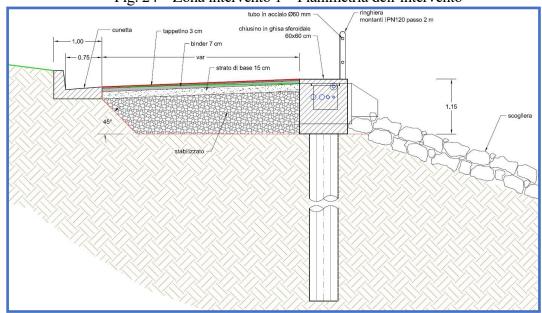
Zona intervento 1 – Sezione tipo dell'intervento
